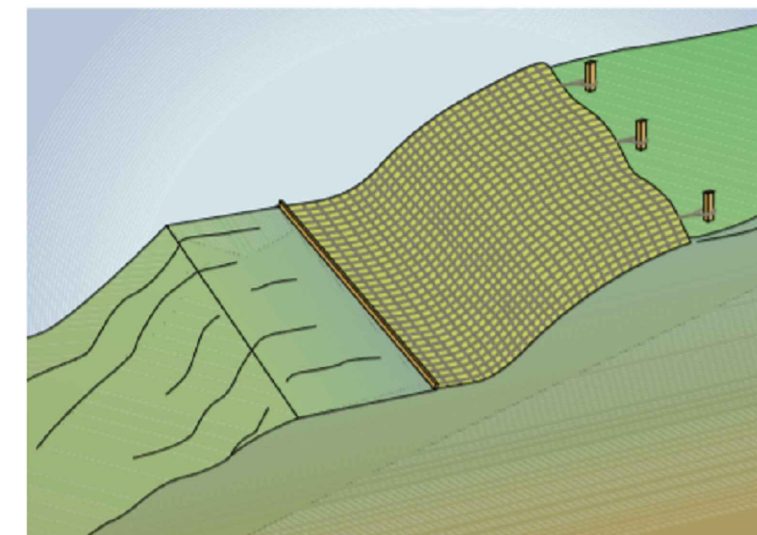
Escavação protegida – com estruturas denominadas "cortinas"
